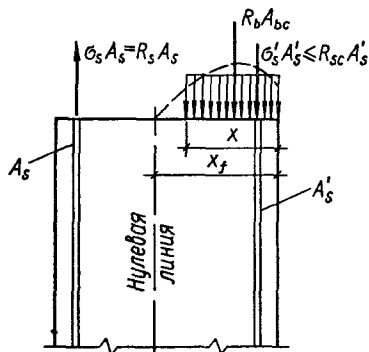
Схема внутренних усилий в сечении железобетонного элемента
